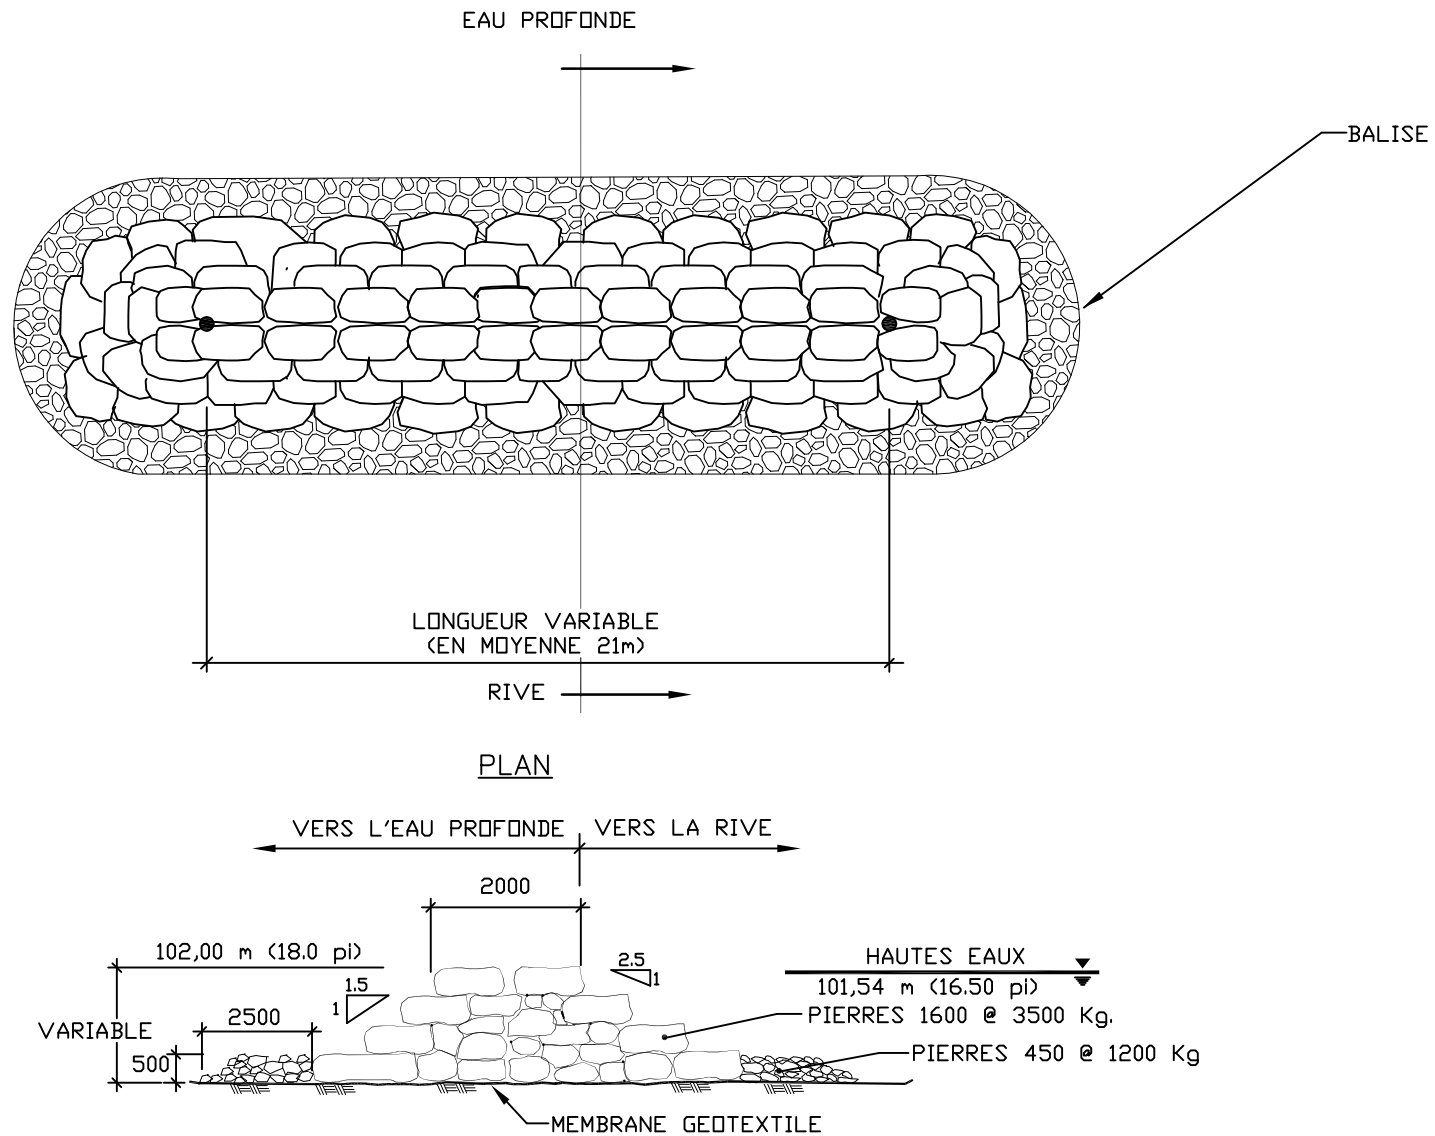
Coupe type d'un brise-lames de construction "classique"
